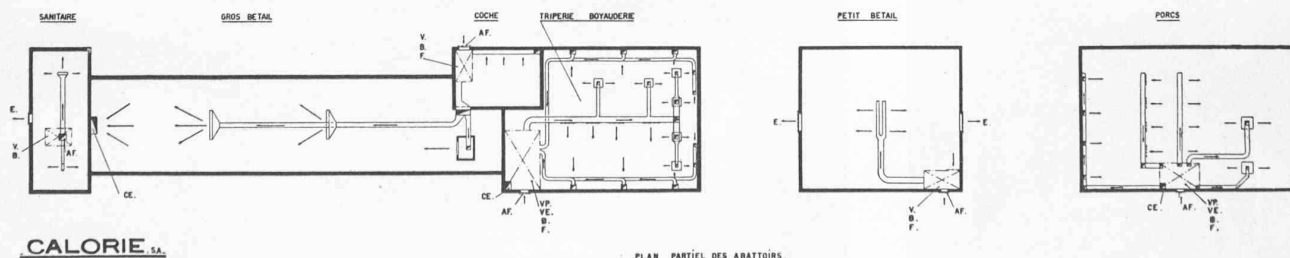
Halles d'abattage. Plan des installations de ventilation.
